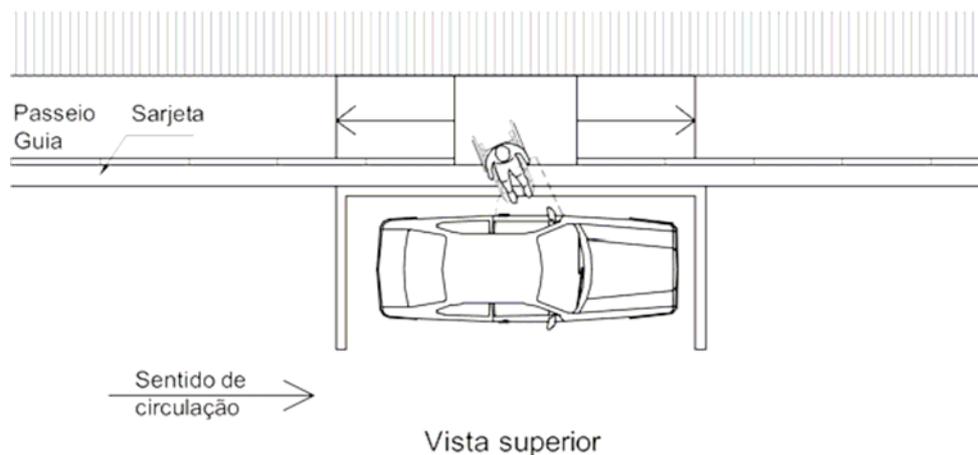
Vagas para estacionamento junto a passeio rebaixado.
